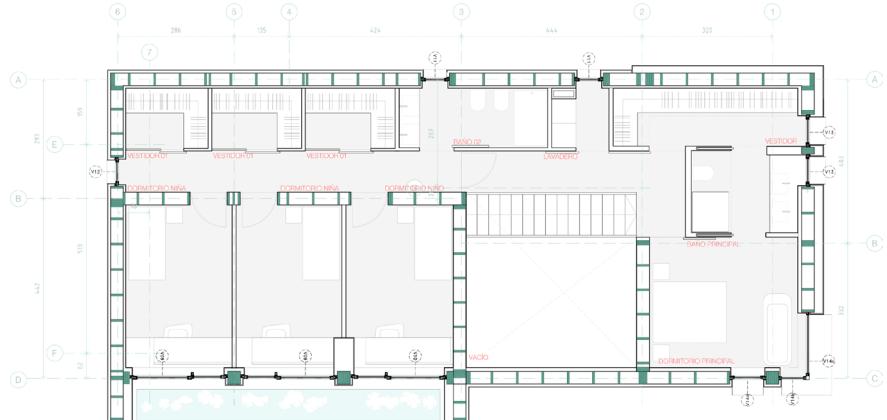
Planta vivienda Rivas. En verde los montantes estructurales del entrámado prefabricado. Casi se realiza el contacto exterior-interior (Natural Concept, 2015)
